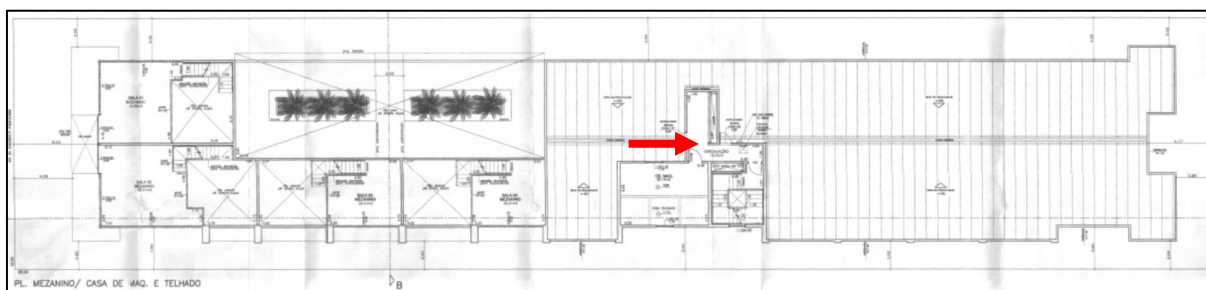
Laje de cobertura do sétimo pavimento.
